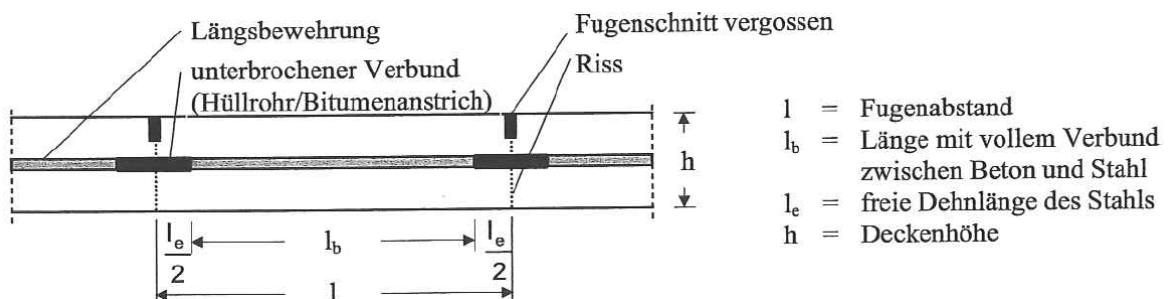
Durchgehend bewehrte Betondecke mit gesteuerter Rissbildung und elastischer Plattenkopplung [57]
